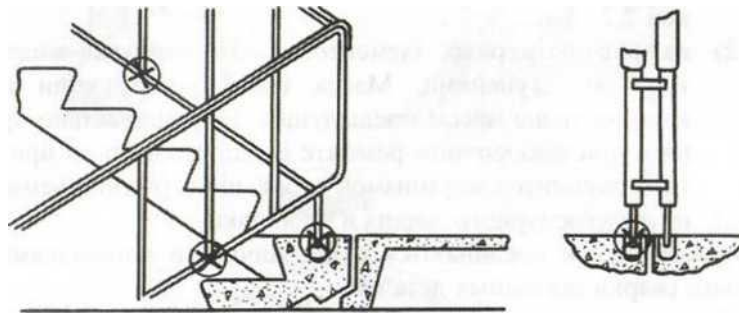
Характерные повреждения лестничных ограждений: расширение вследствие слабого крепления, нарушения сварных соединений решетки вследствие механических воздействий.
